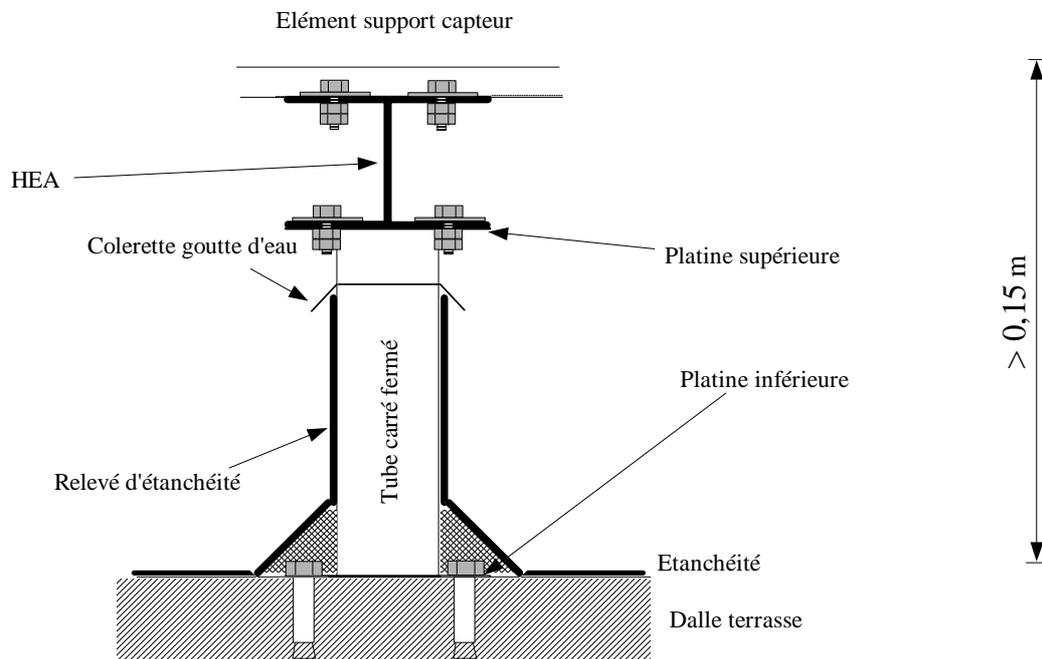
Détail de la fixation des plots métalliques à la toiture terrasse
